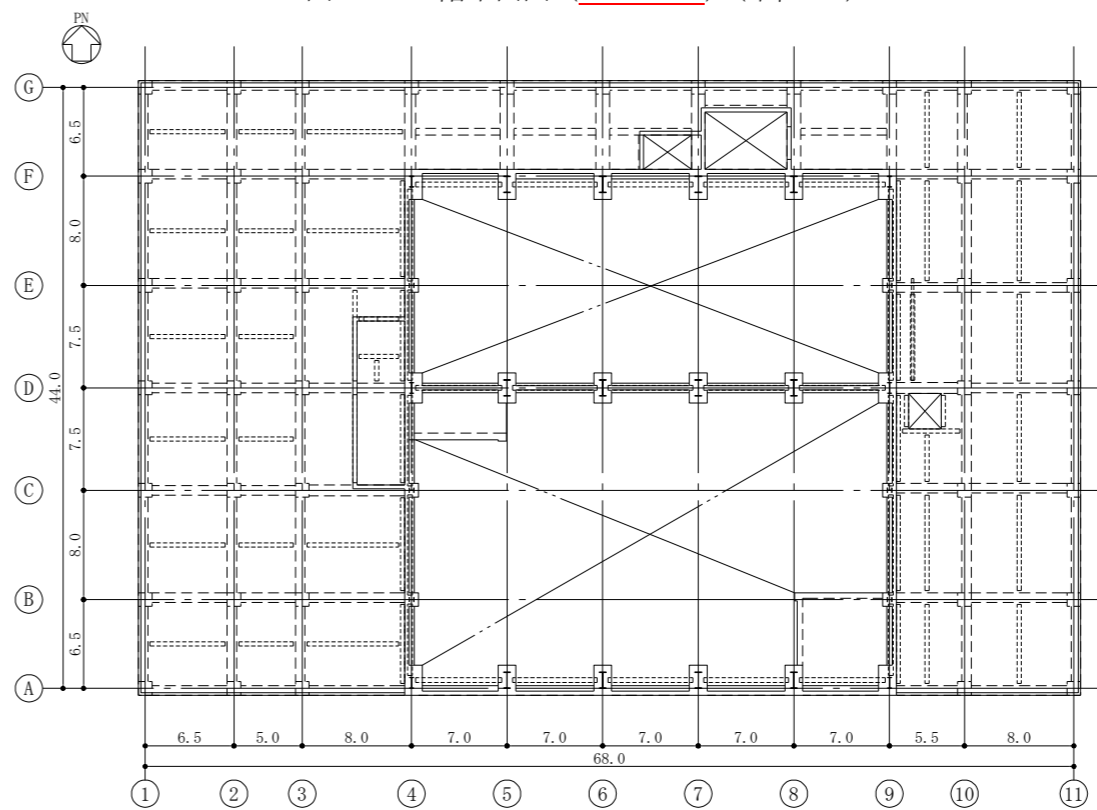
屋根平面図 (その1) (G.L.+21.3) (単位:m)
